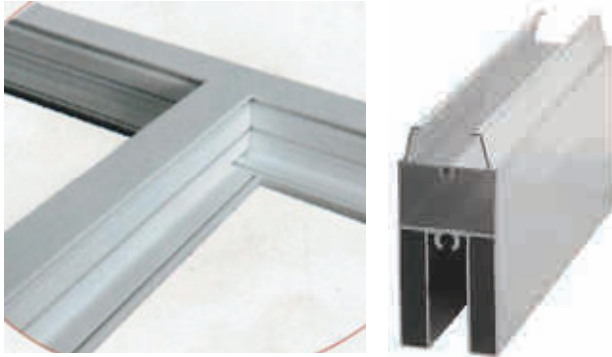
Perfiles intermedios retestados para compatibilizar su ensamblaje
